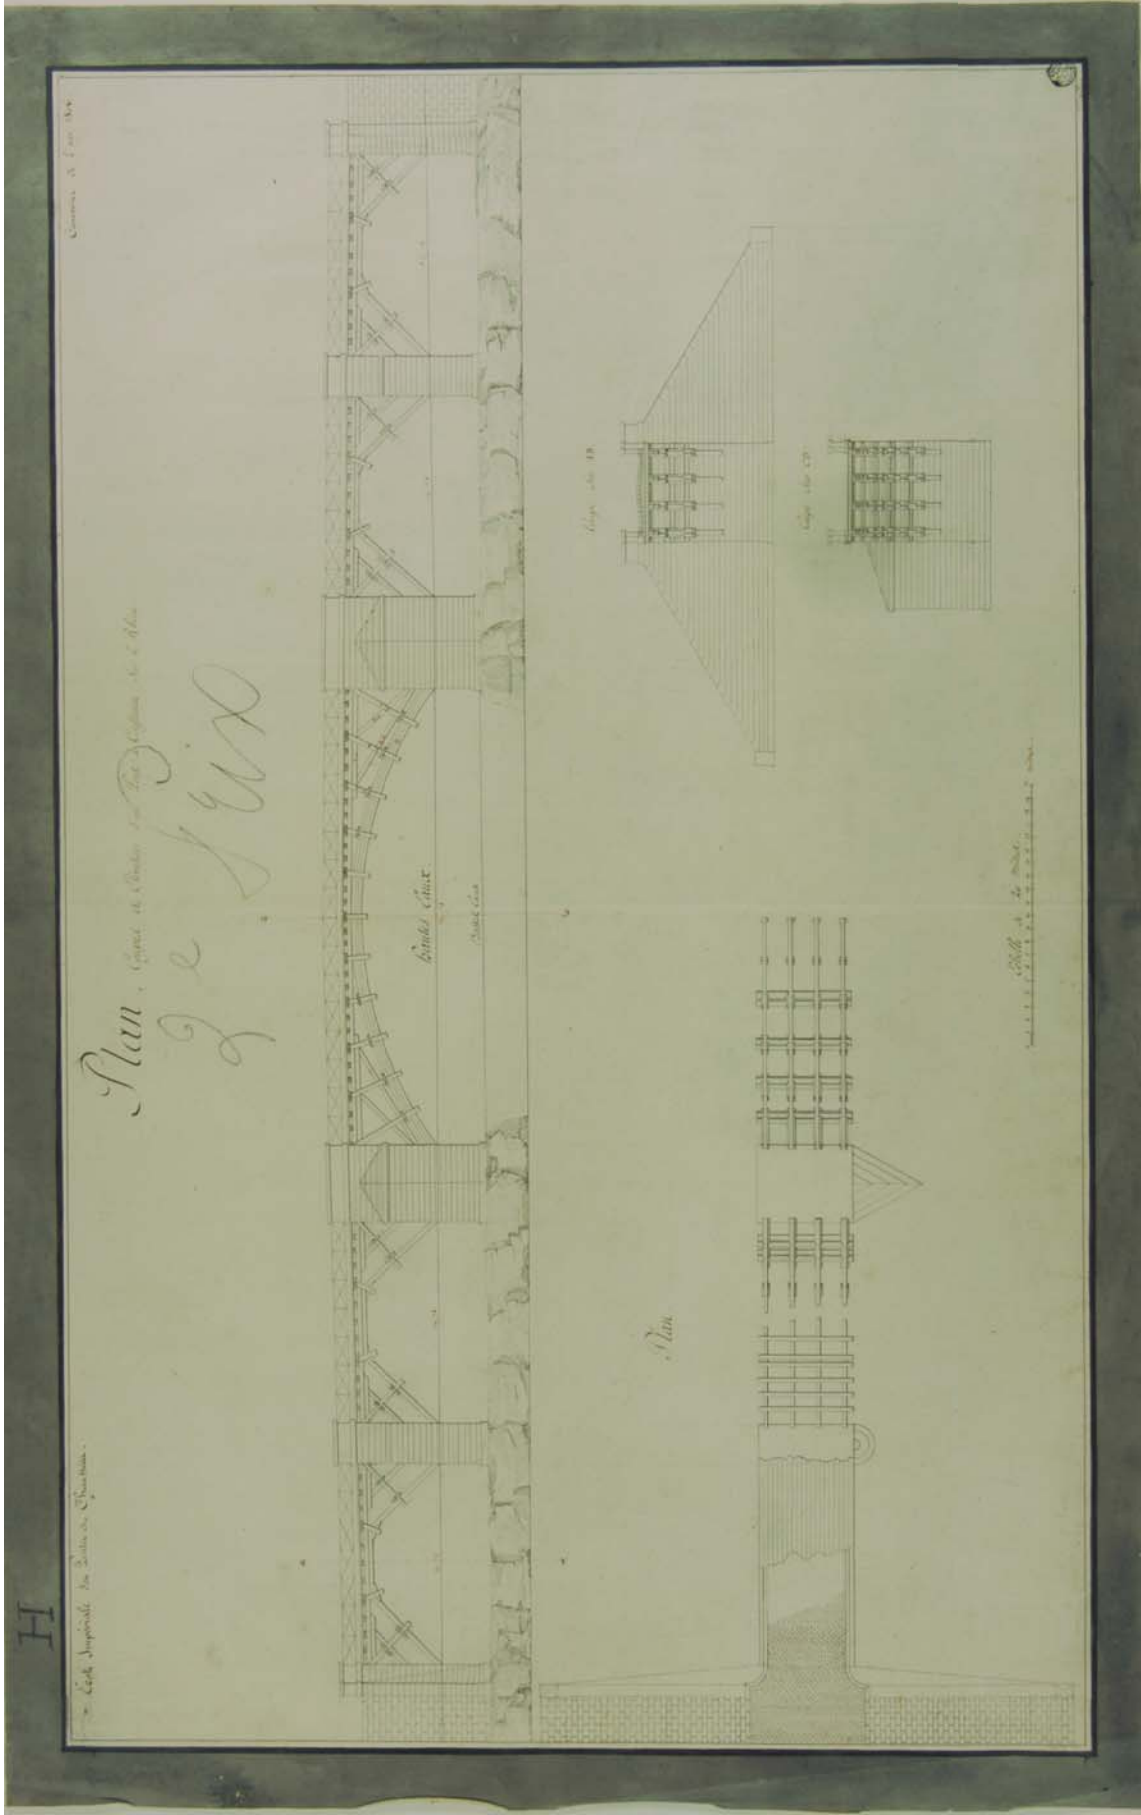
DG 466 – Louis Marie Martret-Preville. Plan Coupe et elevation d'un pont a construire sur le Rhône. 2[^] Prix de pont en bois ou charpente. Arco e puntoni a sostegno dell'impalcato. 1806
